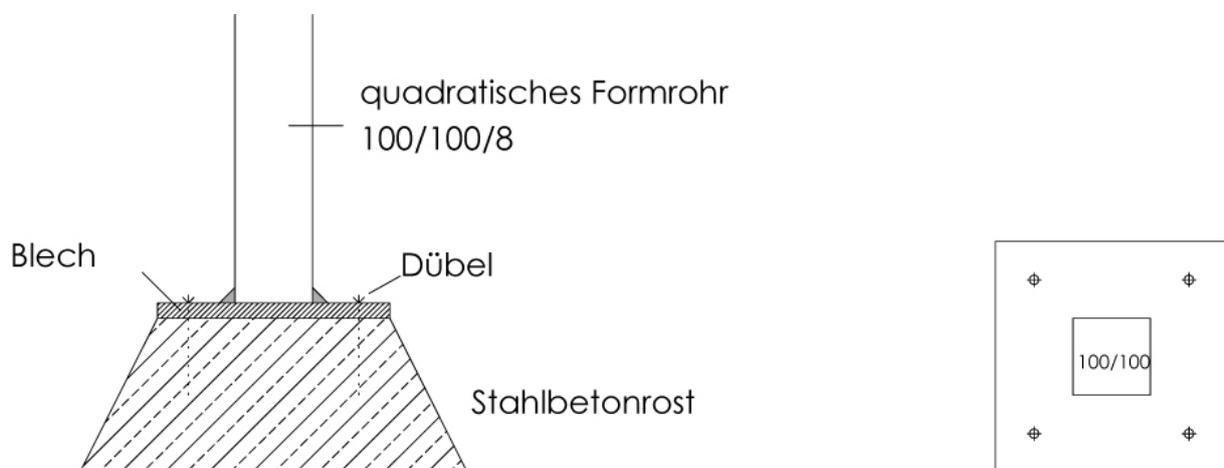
Detail A (M 1:10): Ansicht und GR - Neue Stützen auf Stahlbetonrost
